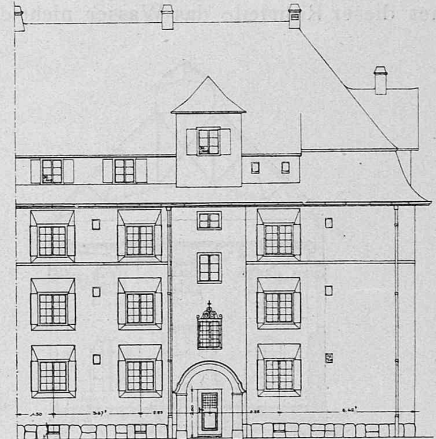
und 4. Bahnseitige Fassade und halbe Strassenfassade. 1:300. — Erbaut 1914 durch das Hochbaubureau der Rh. B., Arch. M. Lorenz.
